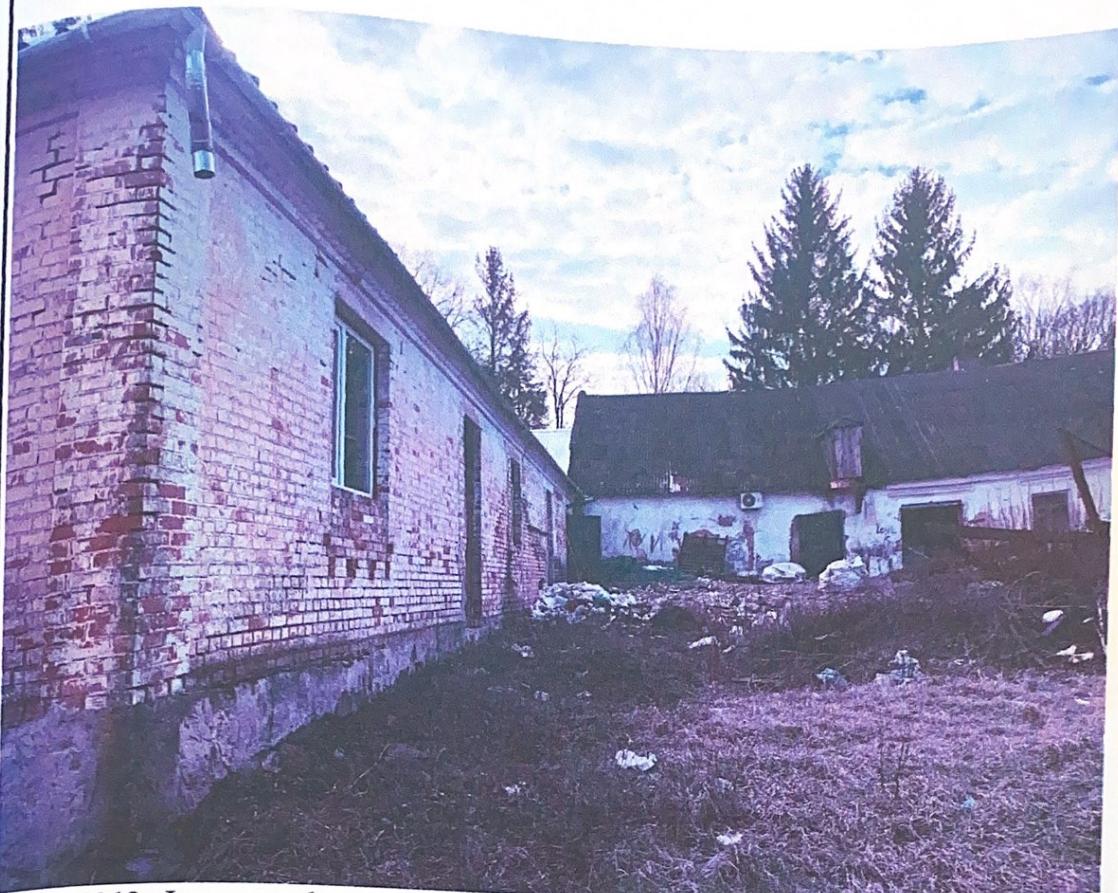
Фрагмент фасаду будівлі старої школи літ.«А» в осіх 6-4, прибудови літ.«А1» в осіх Е-Б.
